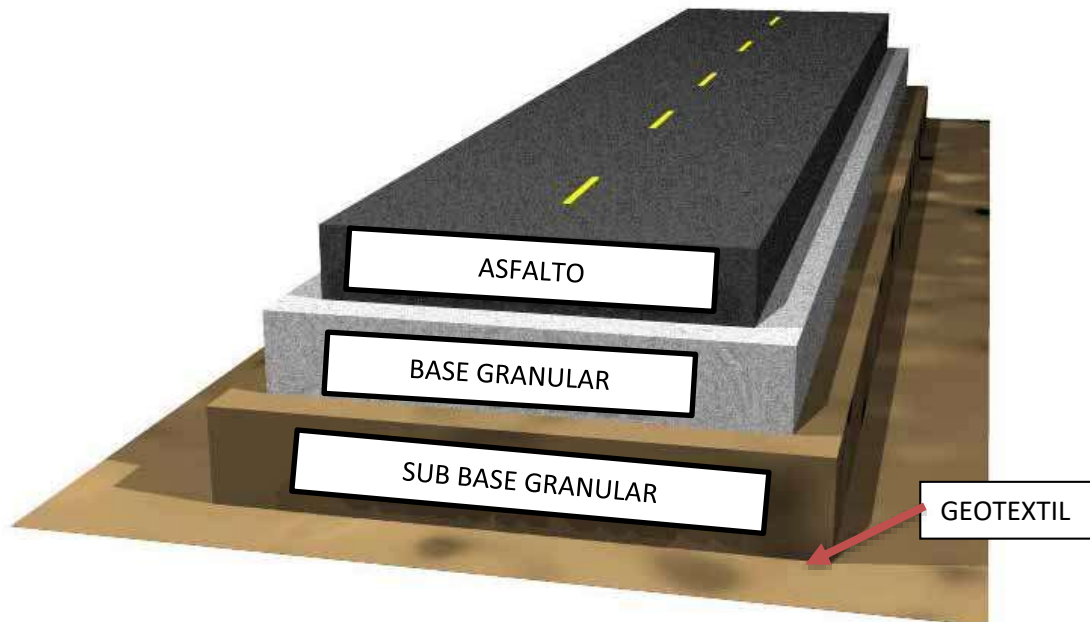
Detalle Estructura Pavimento. Elaboración propia.
